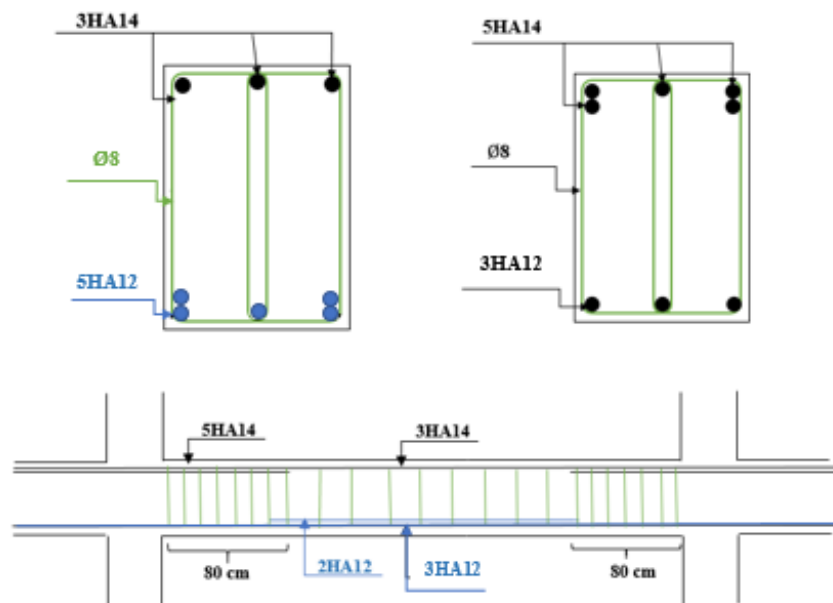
Schéma de ferrailage de la poutre secondaire (30×35).
